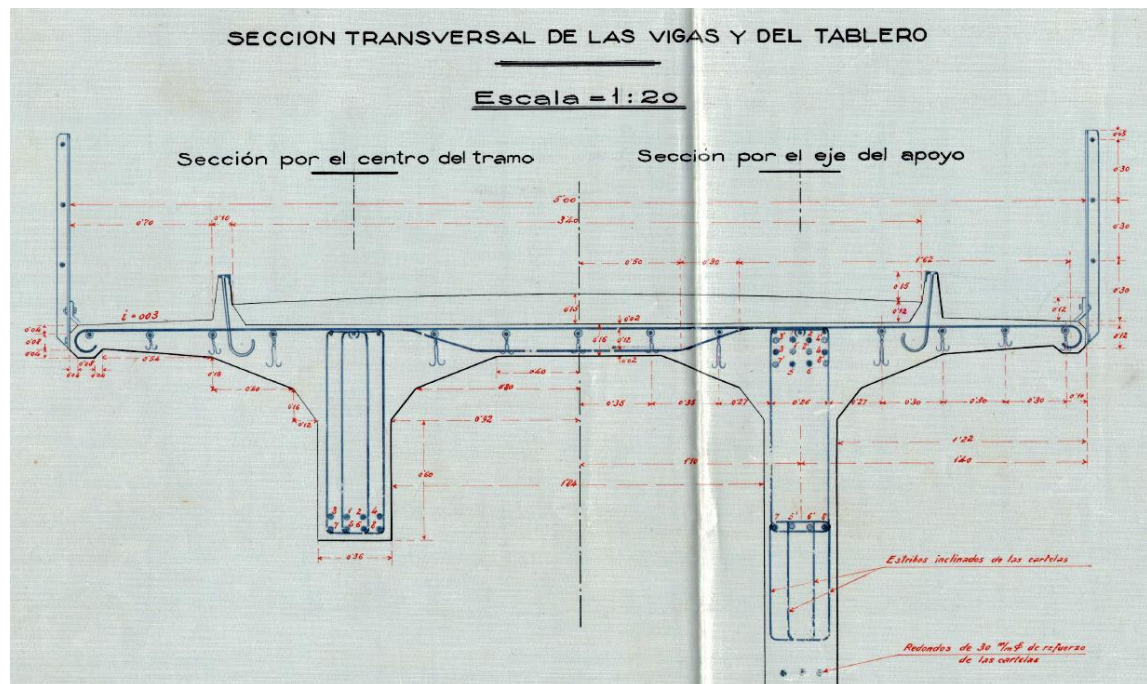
Sección transversal tipo del puente biempotrado [12]
